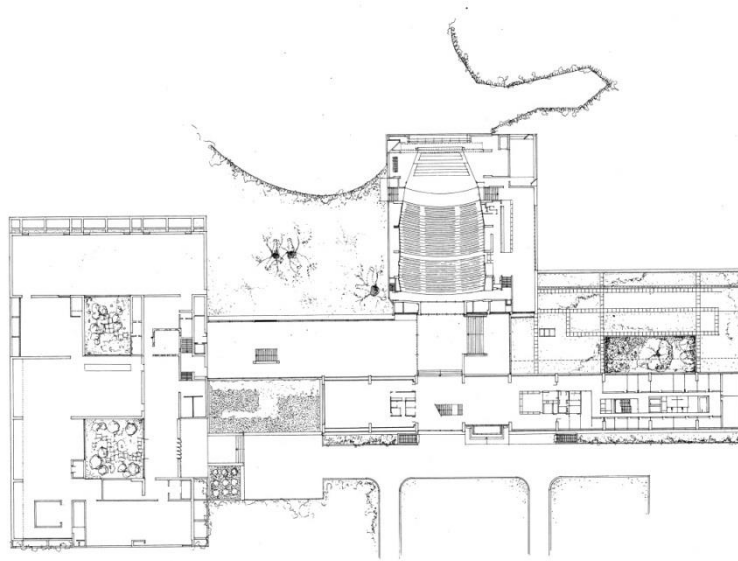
Planta general de la Fundación Calouste Gulbenkian (dibujo de Josep Eixerés)
